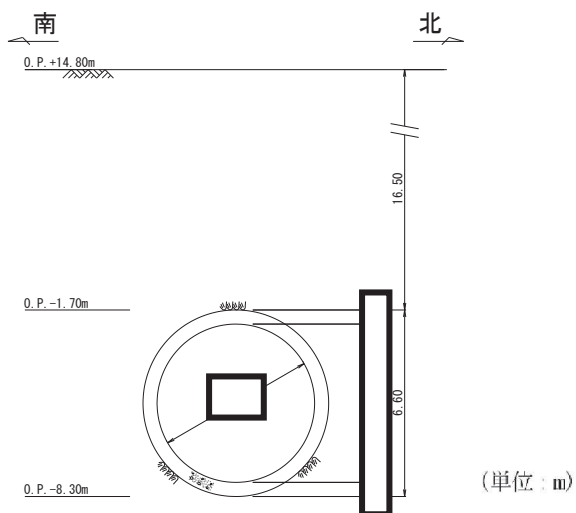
排気筒連絡ダクト断面図 (B-B 断面, 岩盤部)
